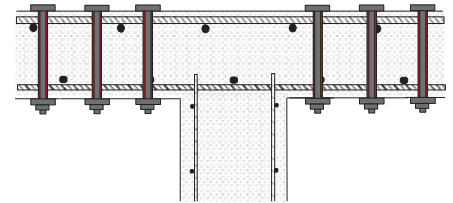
Nachträglich eingebauter, durchführender Bewehrungsanschluss
